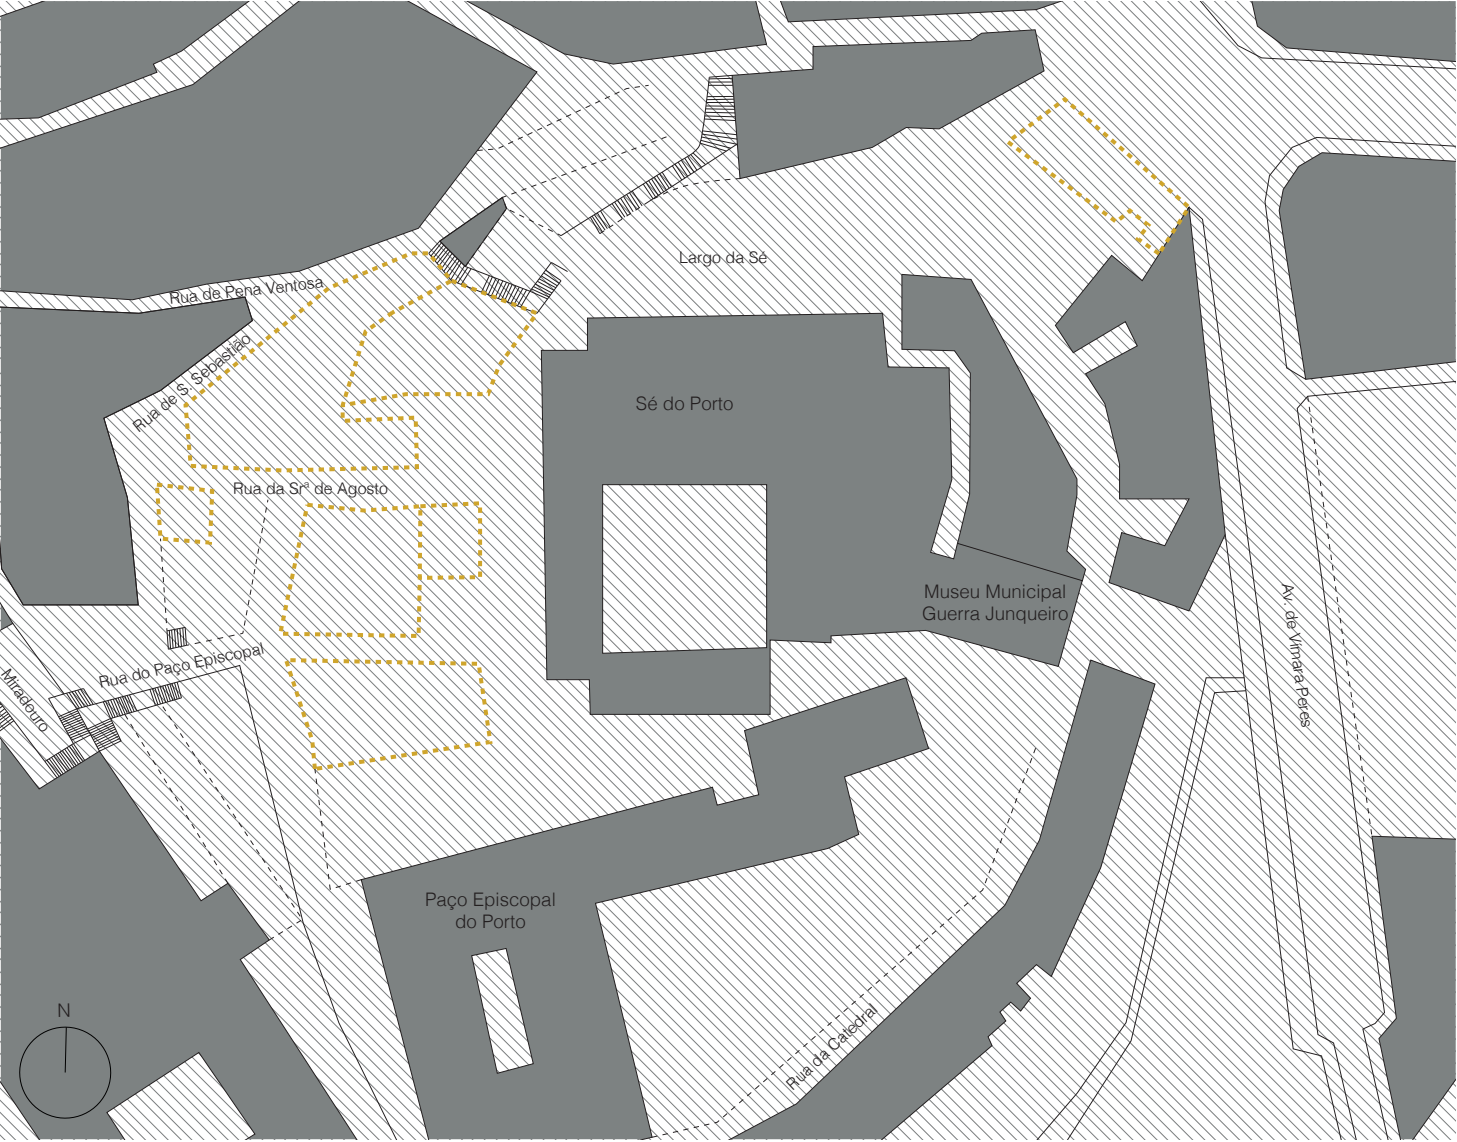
Planta esquemática do tipo cheio/vazio, correspondente à terceira proposta.
